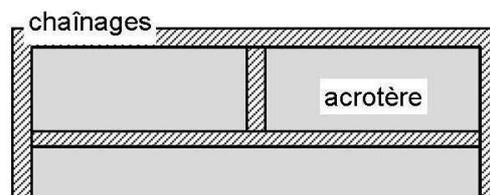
Exemple d'encadrement des éléments en console vertical
